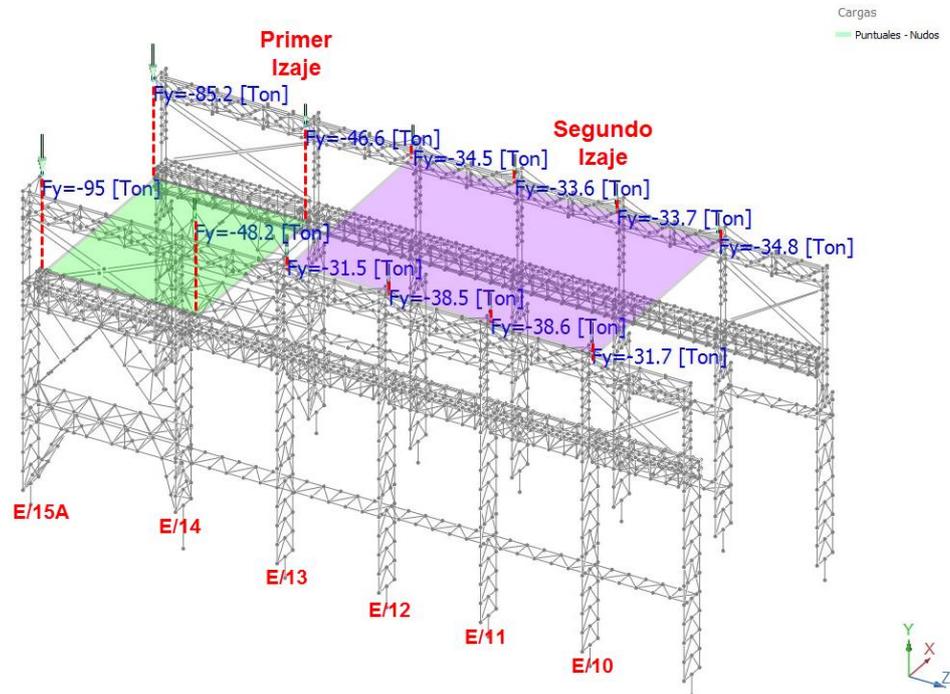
Esfuerzos aplicados en estructura de la nave de acería debido al primer y segundo izaje de la campana de extracción.
